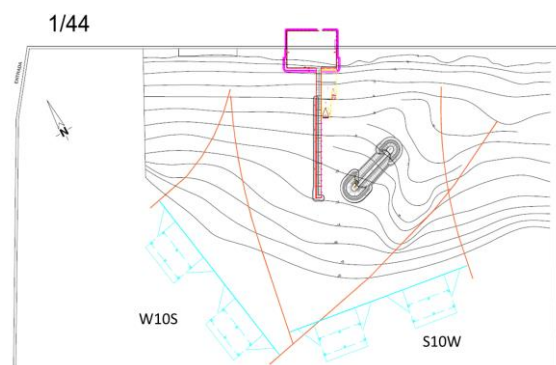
Batimetria e esquema da implantação. Posição dos geradores de ondas
